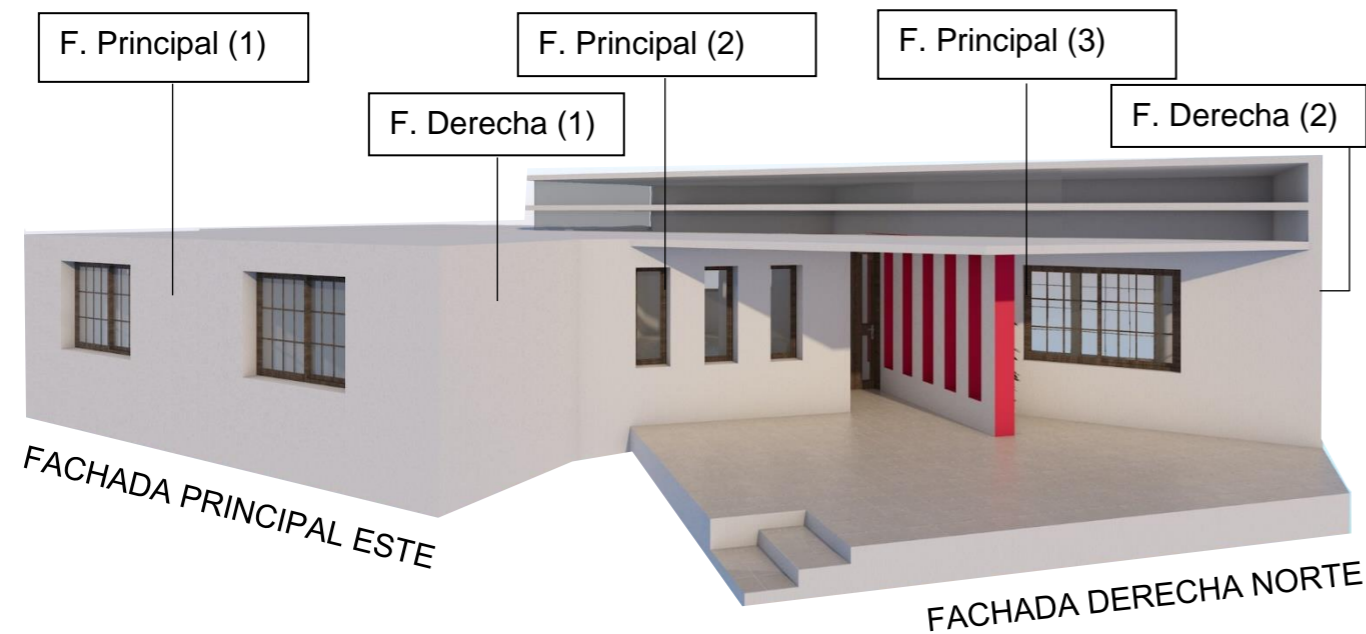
Ubicación de muros en fachada principal este y fachada derecha norte (propia, Elaboración)
